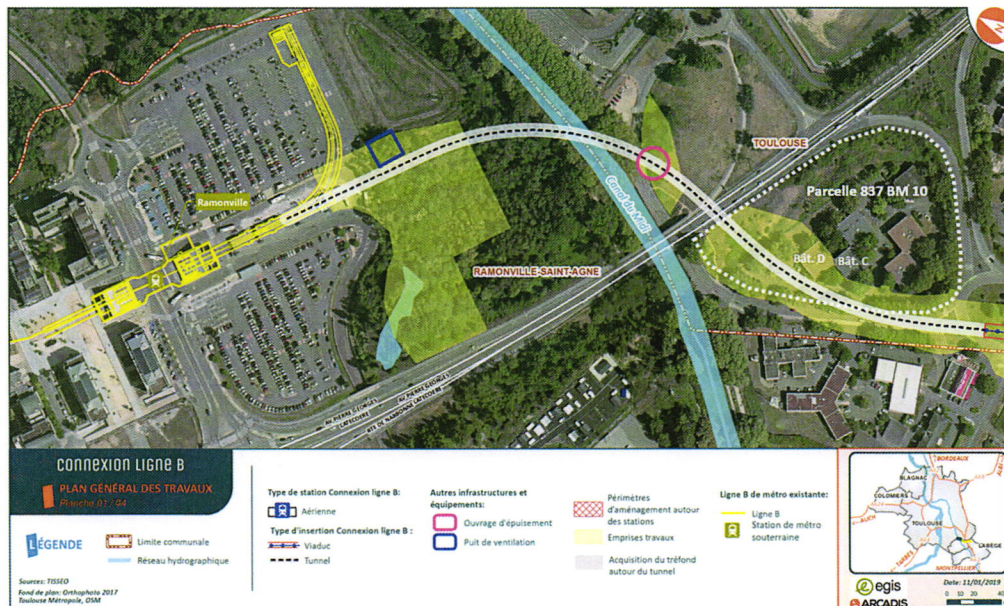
Plan Général des Travaux issu du dossier d'enquête publique
